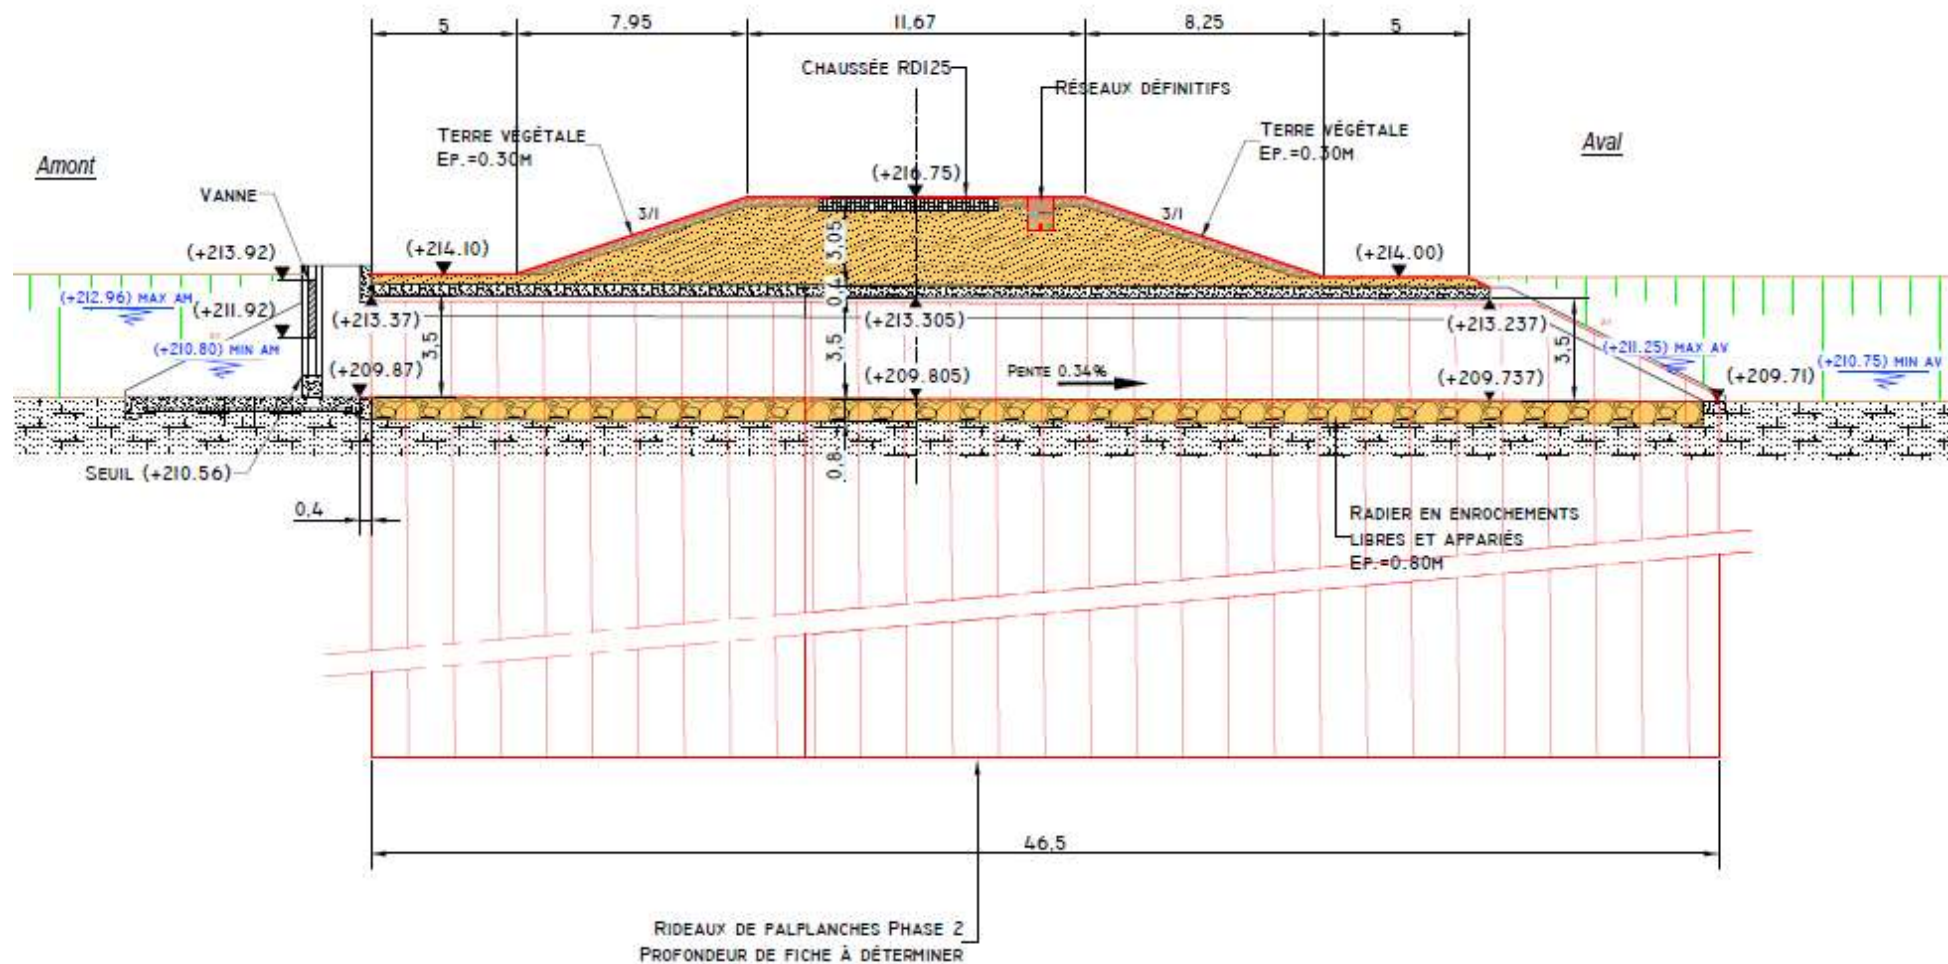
Plans décrivant les travaux – Etat final post travaux – Profil en long.
